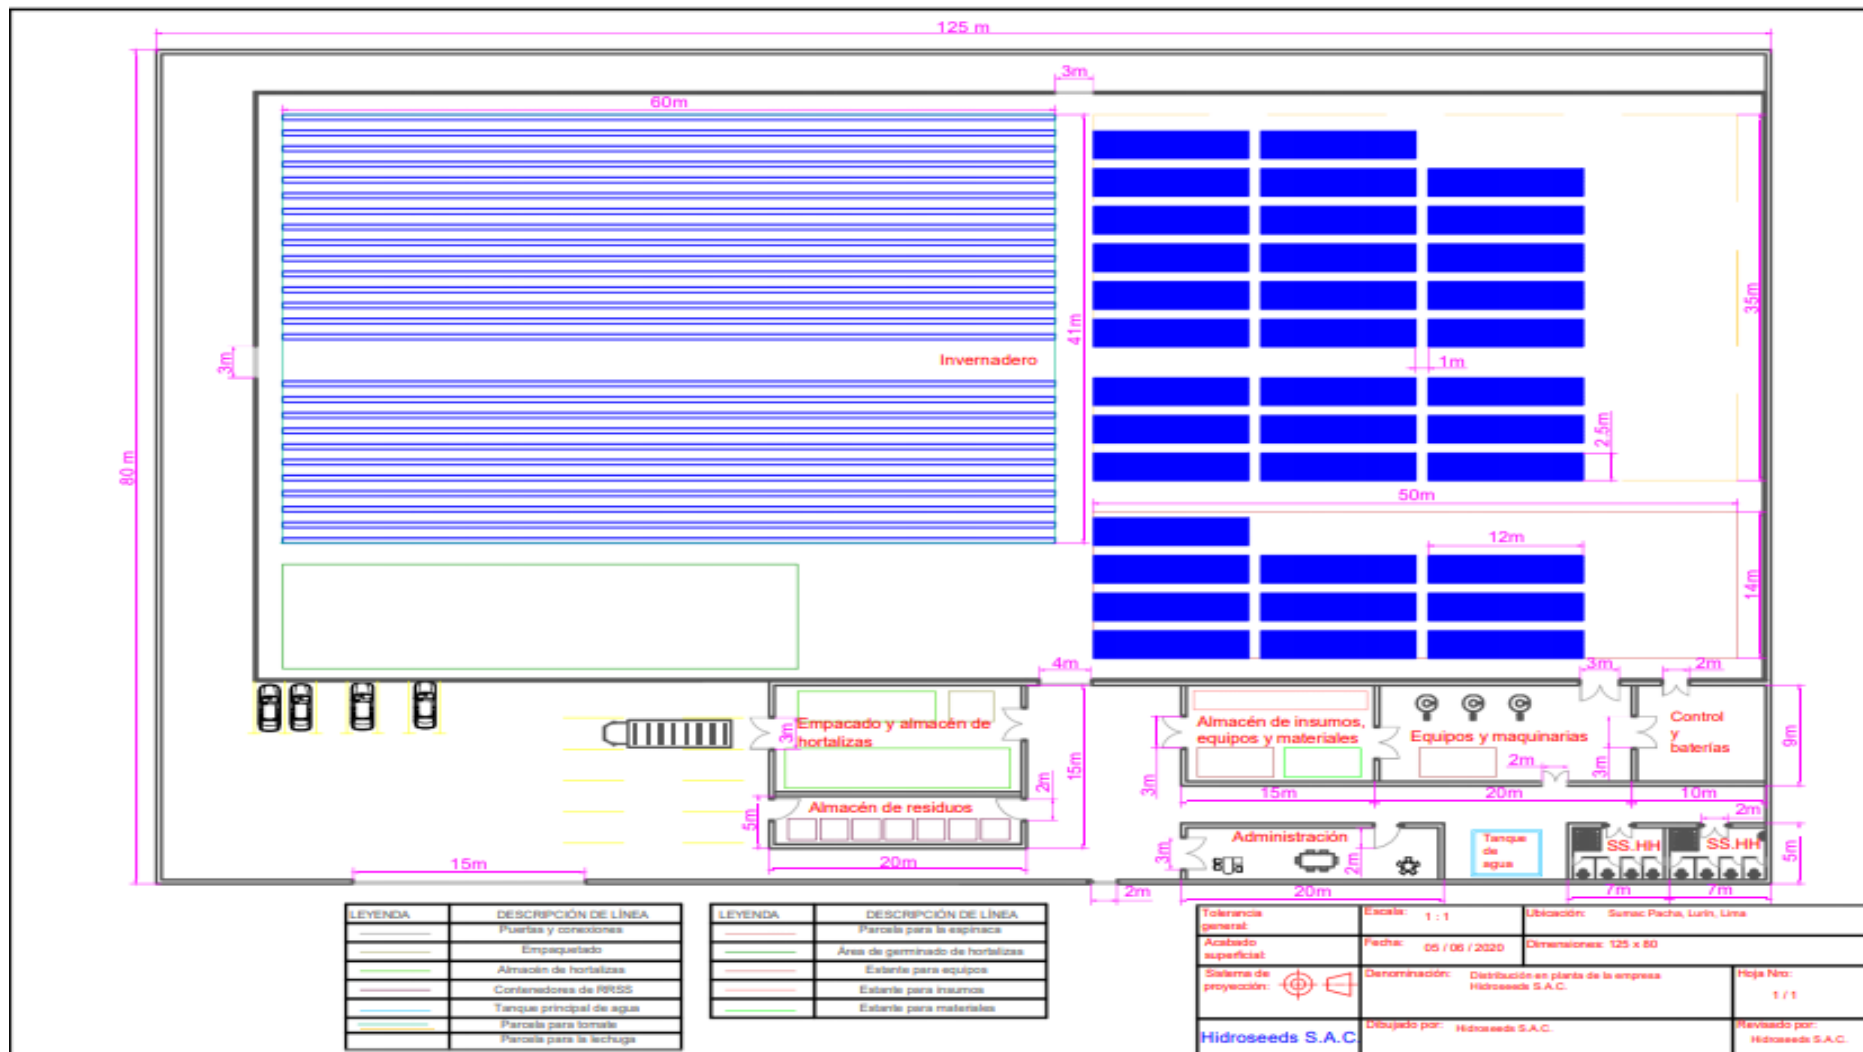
Diseño de la planta de la empresa Hidroseeds S.A.C.
